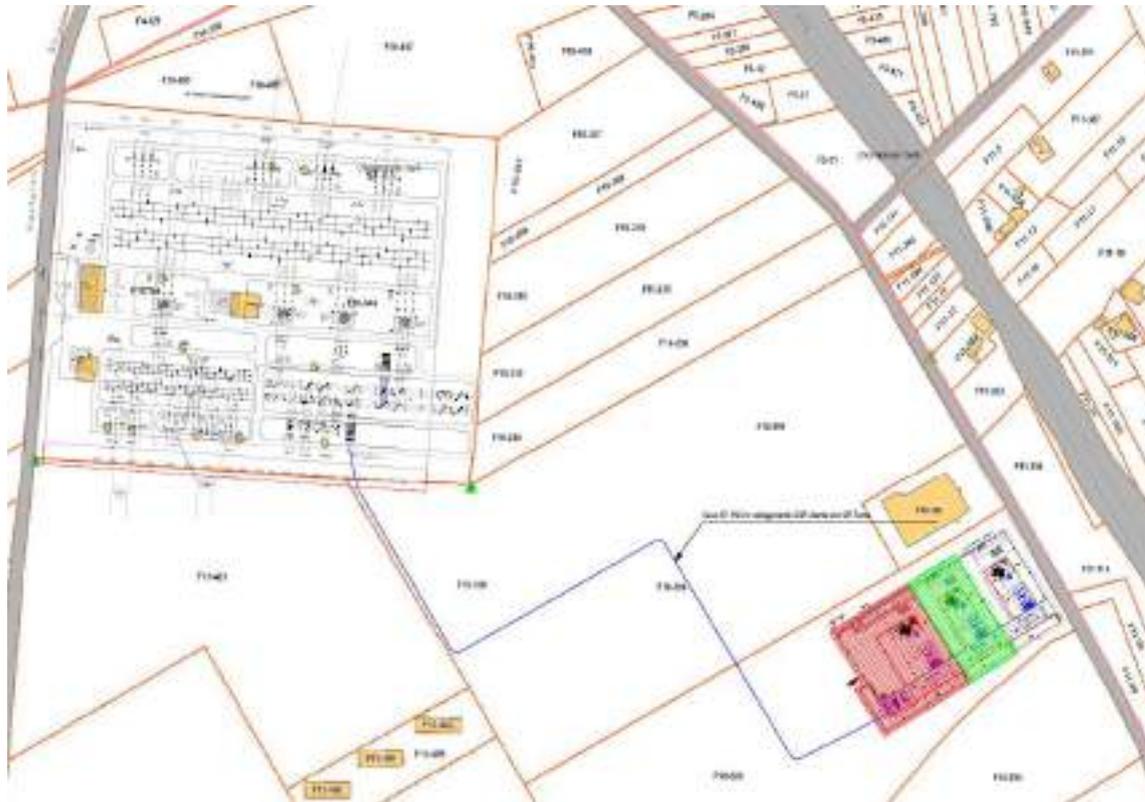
Planimetria generale SSE Chiaramonte Gulfi (RG) e Stallo condiviso
